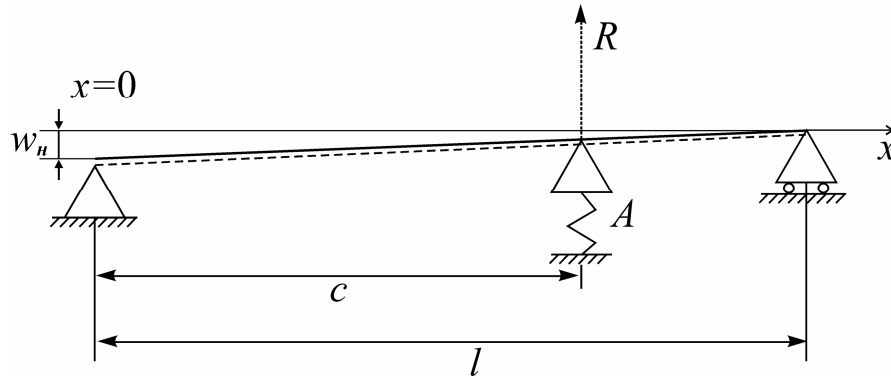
Шарнирно опертая балка с промежуточной упругой опорой и смещением опор в вертикальном направлении
